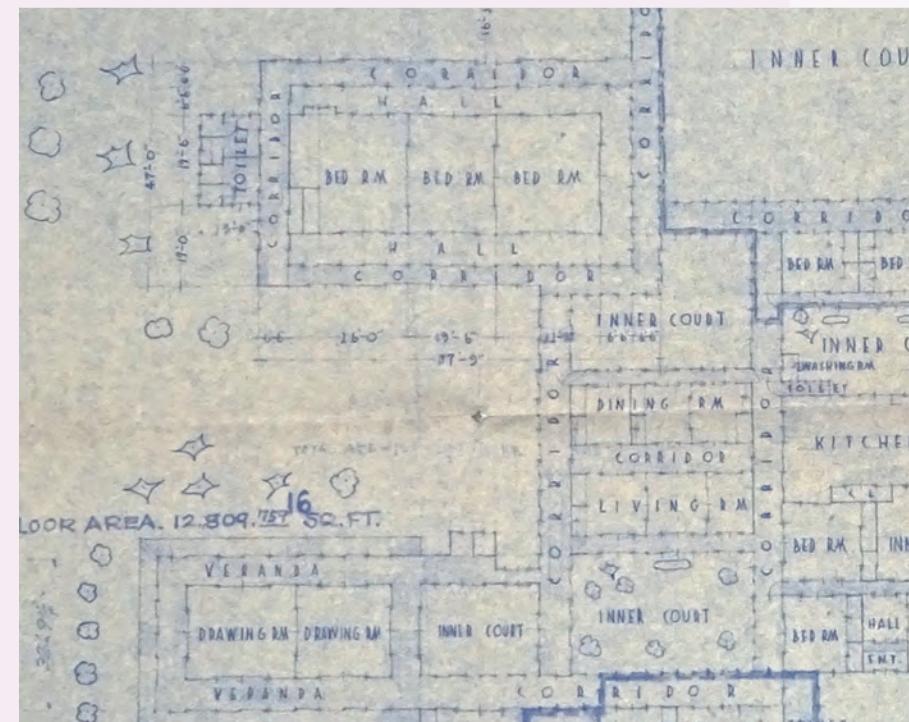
GHQ 接收時の披雲閣平面図 (部分)
